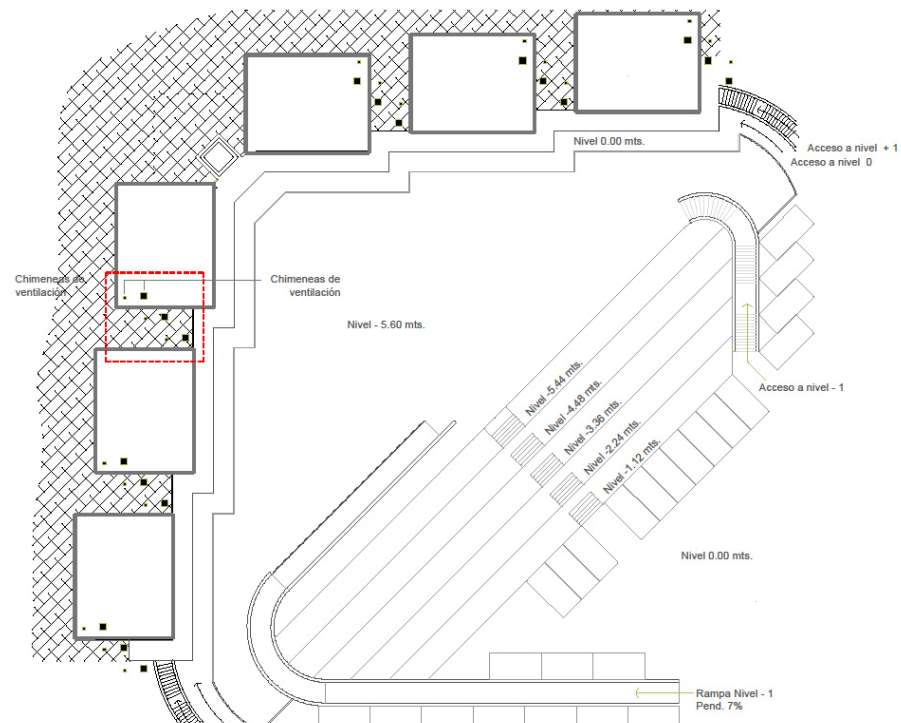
Localización en planta de las salidas de aires a través de las chimeneas de ventilación.
